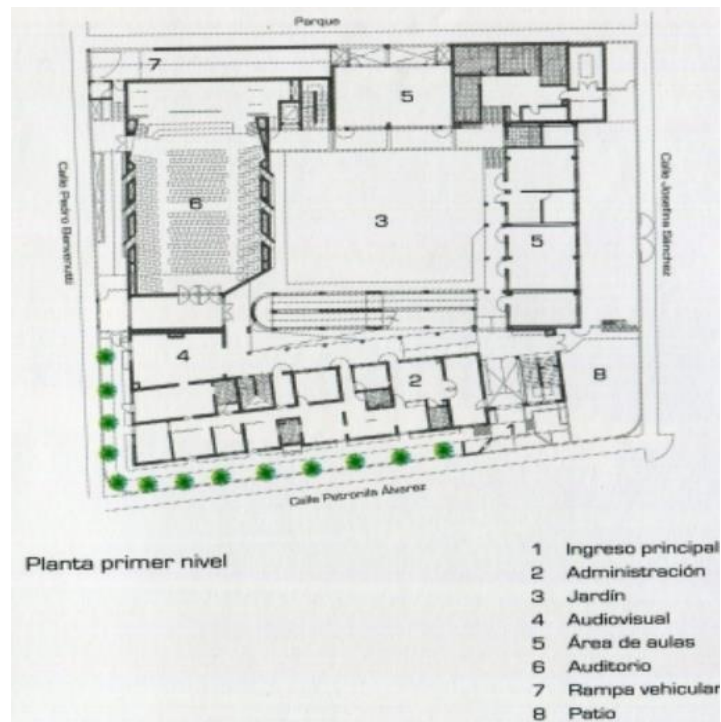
Planta primer nivel, Centro Especializado Ann Sullivan
